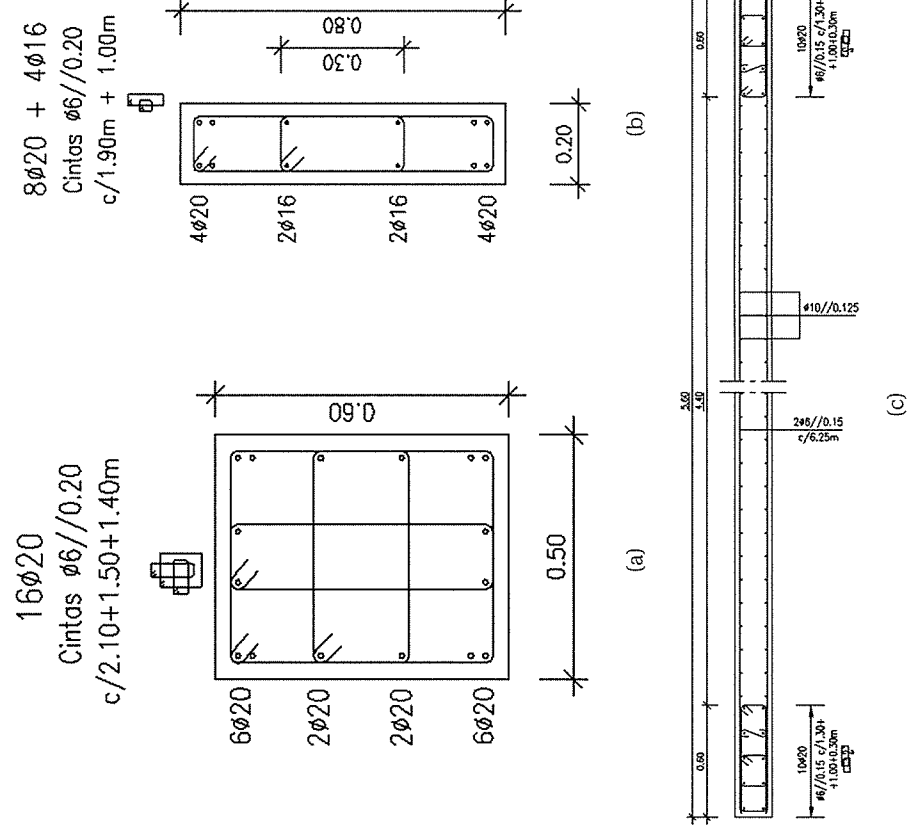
Características das seções dos elementos de suporte em estudo; (a) Pilar tipo 1; (b) Pilar tipo; (c) Parede resistente
